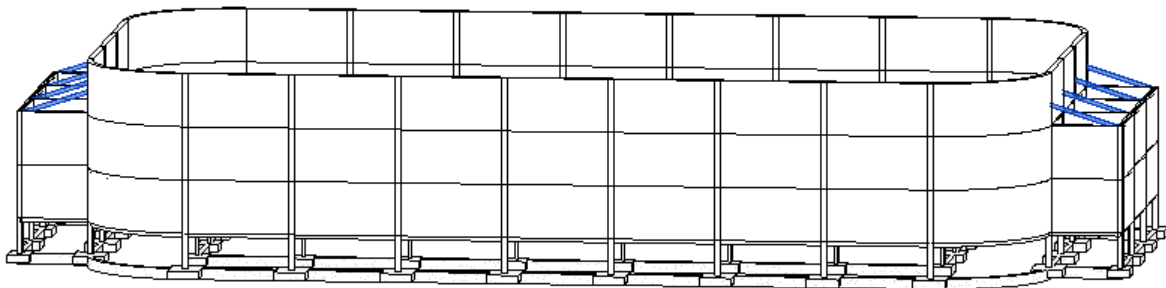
Colocación de las distintas vigas que soportarán las cubiertas laterales
